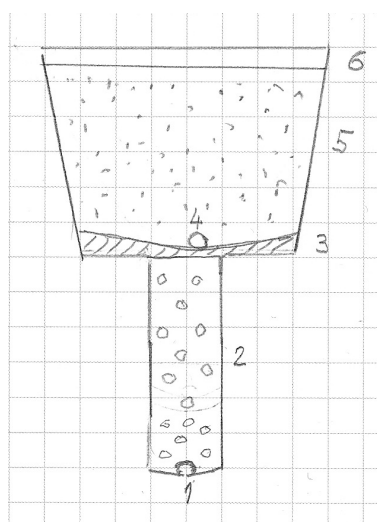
schéma d'équipement des parties captantes des tranchées. 1 : PE perforé. 2 : massif filtrant (gravier grossier arrondi). 3 : étanchéité (argile sur béton maigre ou géotextile bentonite). 4 : PVC perforé pour eaux sauvages. 5 : remblaiement par matériel d'excavation ou matériel argileux compacté. 6 : sol à reconstituer.
